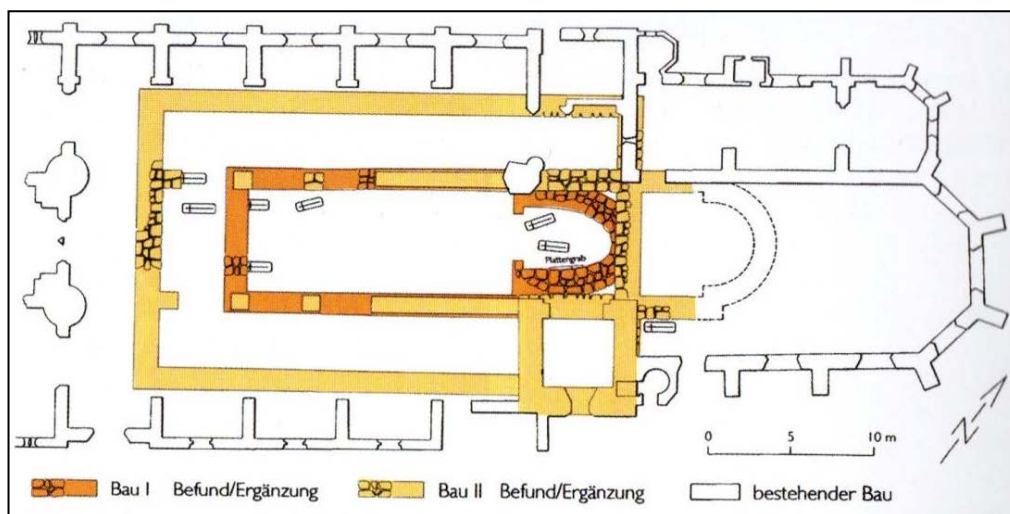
Stiftskirche von Stuttgart mit Vorgängerbauten
